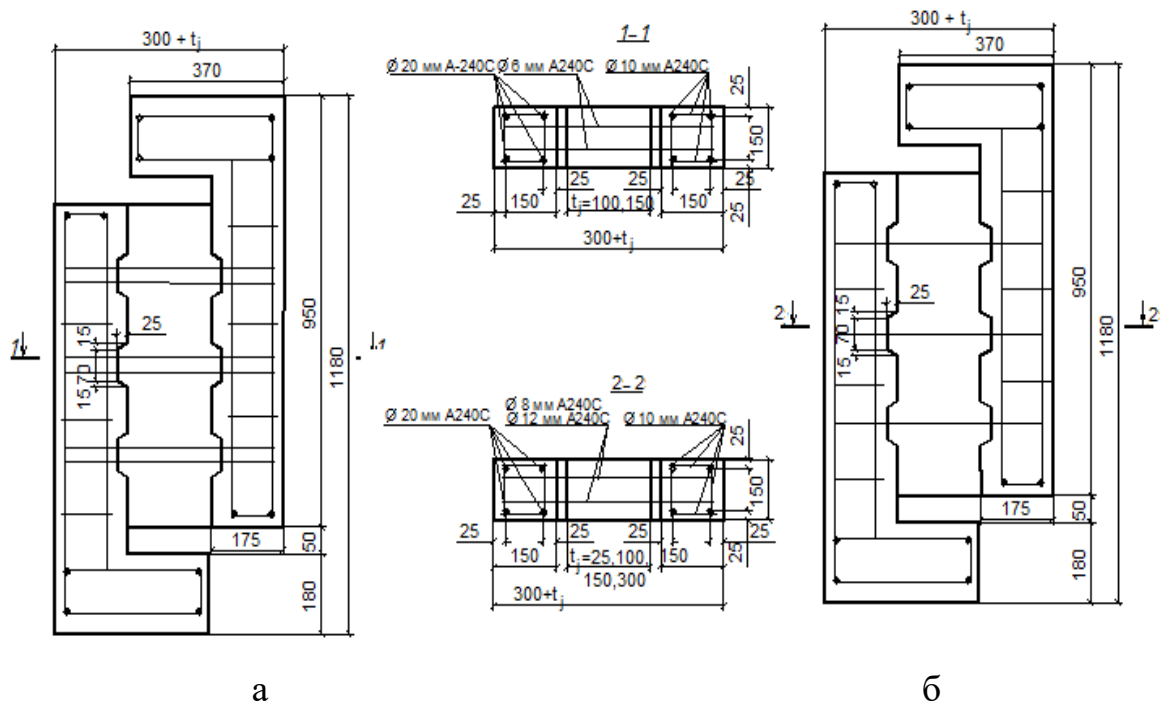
Конструкція та схеми армування стиків із фібробетону:
